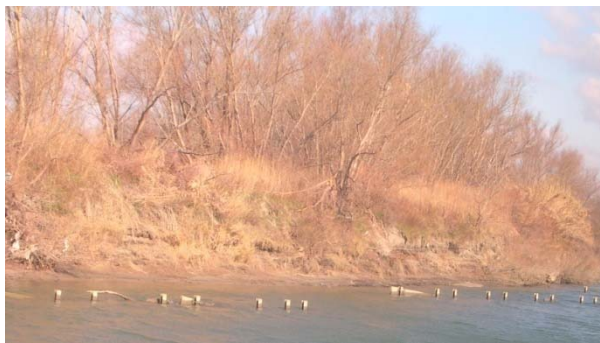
Implantation des panneaux de fond sur une rive concave du Petit Rhône. Les pieux et quelques dalles de bétons apparaissent en surface (Photo Raccasi)
